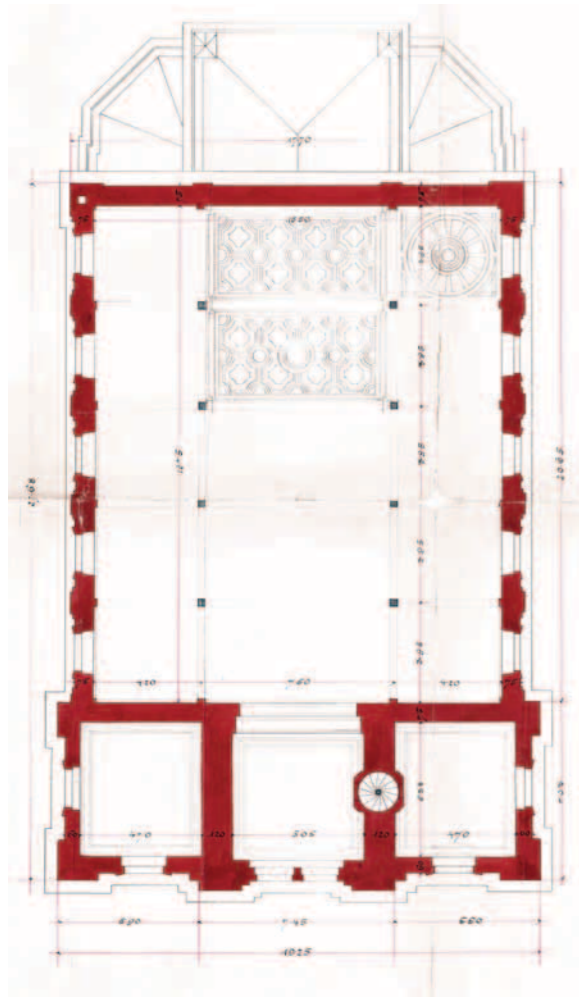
Grundriss Turmgeschoß und Plafond
